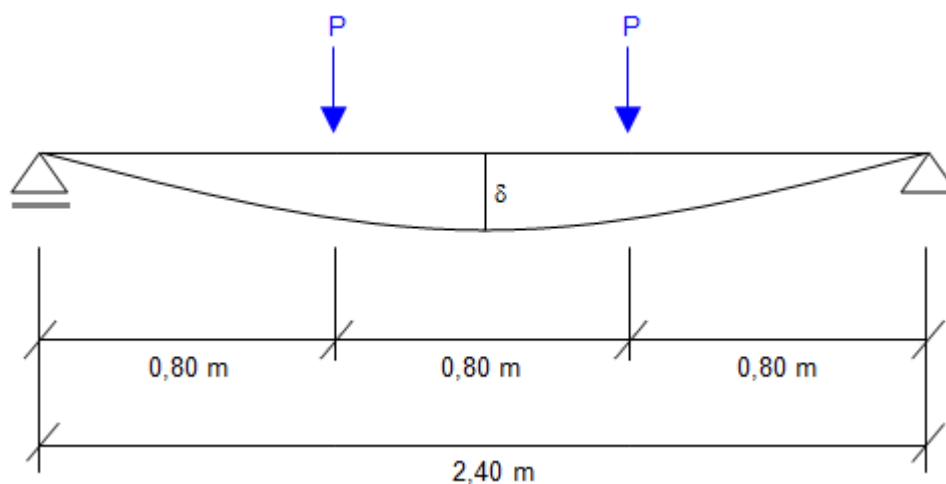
Carregamento e geometria das vigas ensaiadas por Álvares (1993).
